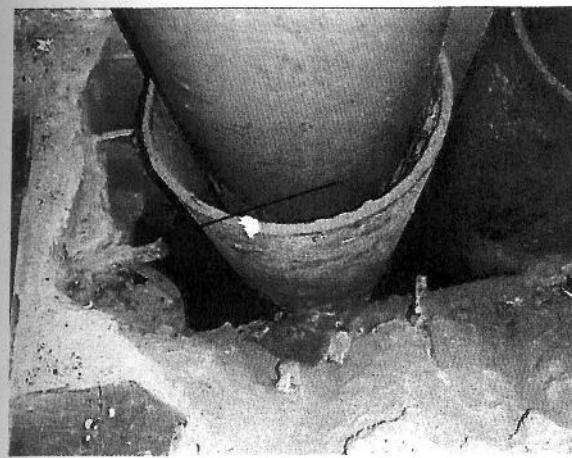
605 корп., 12 секция, лестничная площадка проделанное отверстие – срезана арматура
